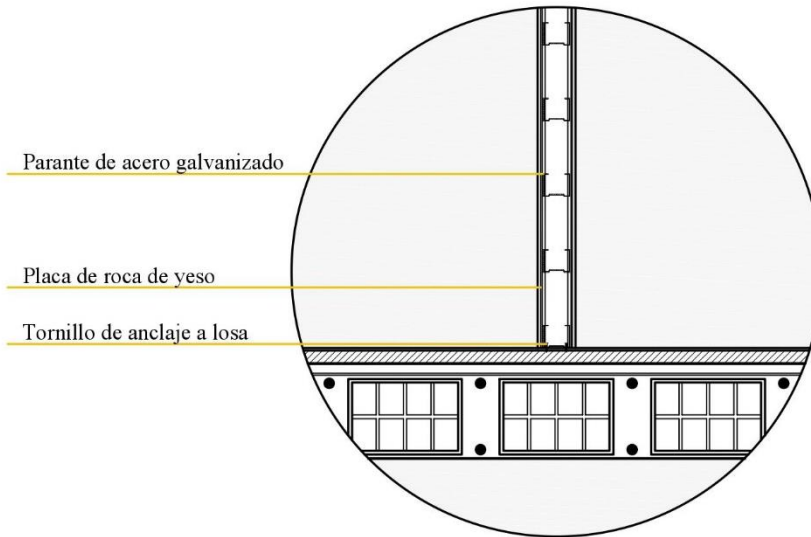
Detalle de sistema Drywall. Fuente: Propia
